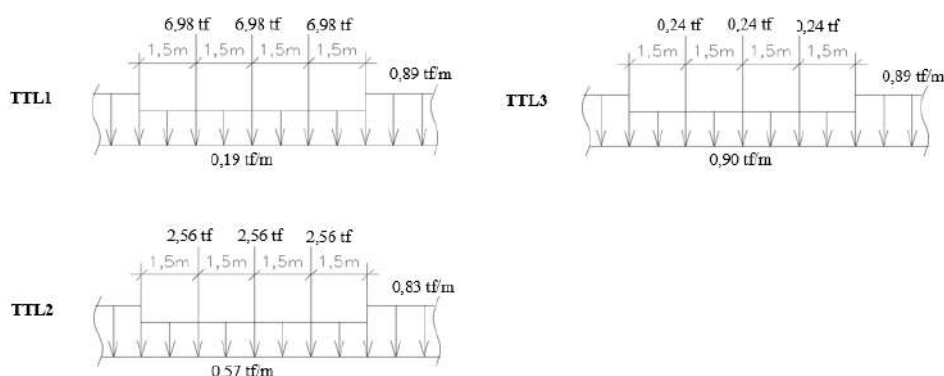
Trens-tipos longitudinais para as vigas longitudinais.
